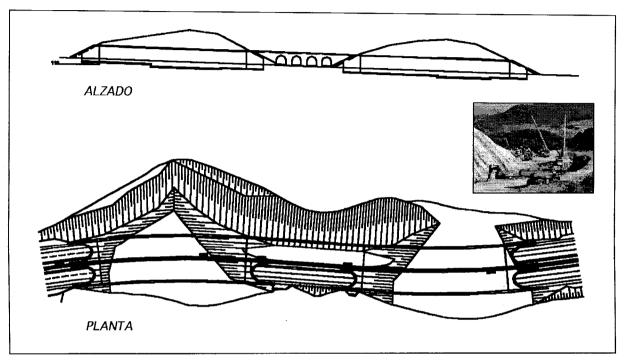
Planta y alzado de uno de los falsos túneles diseñados para la Autovía A-381 Jerez-Los Barrios. Falso túnel nº2, tramo VI. Instantánea de los trabajos de construcción donde se aprecia el fuerte desmonte que quedaría sin la ejecución de este tipo de obras.
